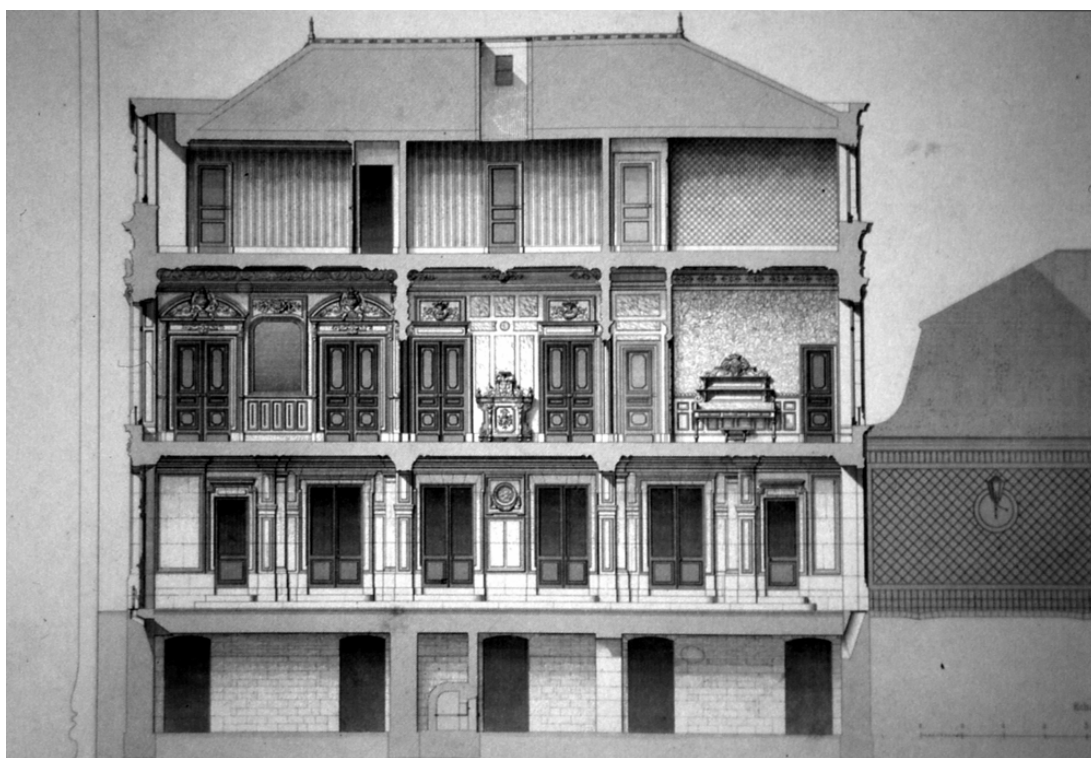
César Daly, 1860. *Hotel privé Boulevard Morceaux.
